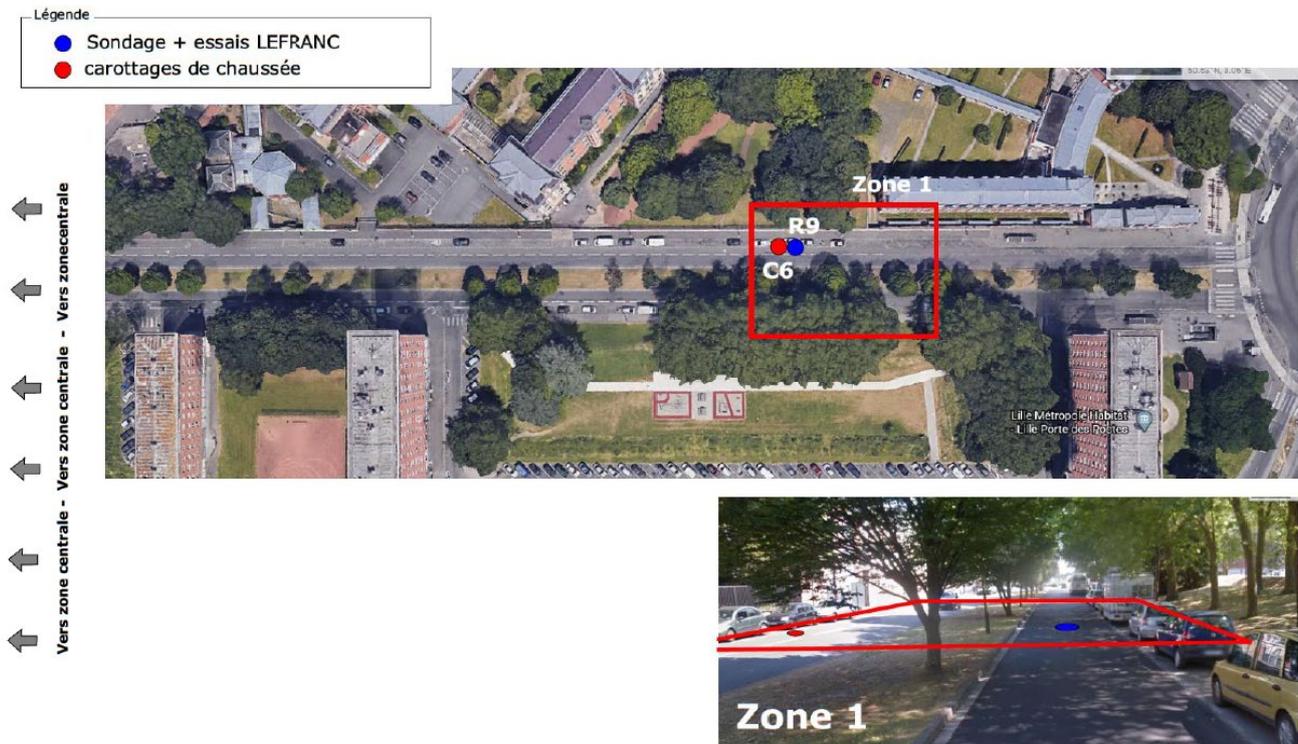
Plan de repérage – boulevard de Metz - ouest
